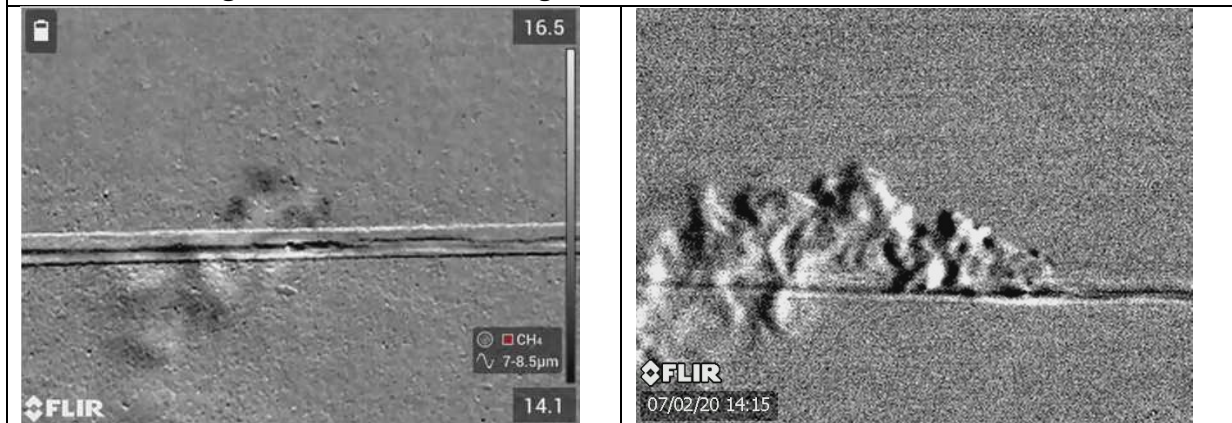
Riss in der Decke eines Betonfermenters
